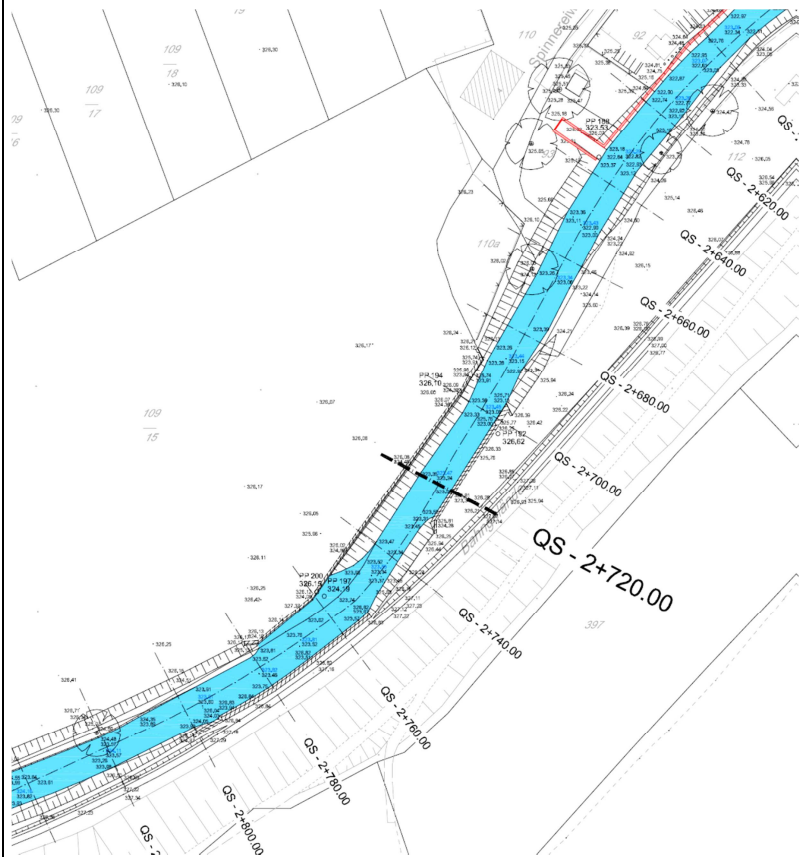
4.5.4: Lageplanausschnitt mit Schnittpur 2+720
